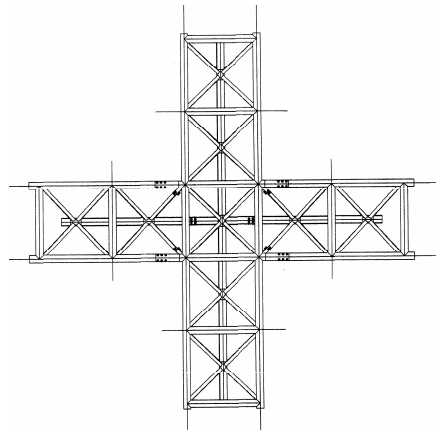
Módulo Estructural Básico propuesto por Aceros Prefabricados, S. A.
